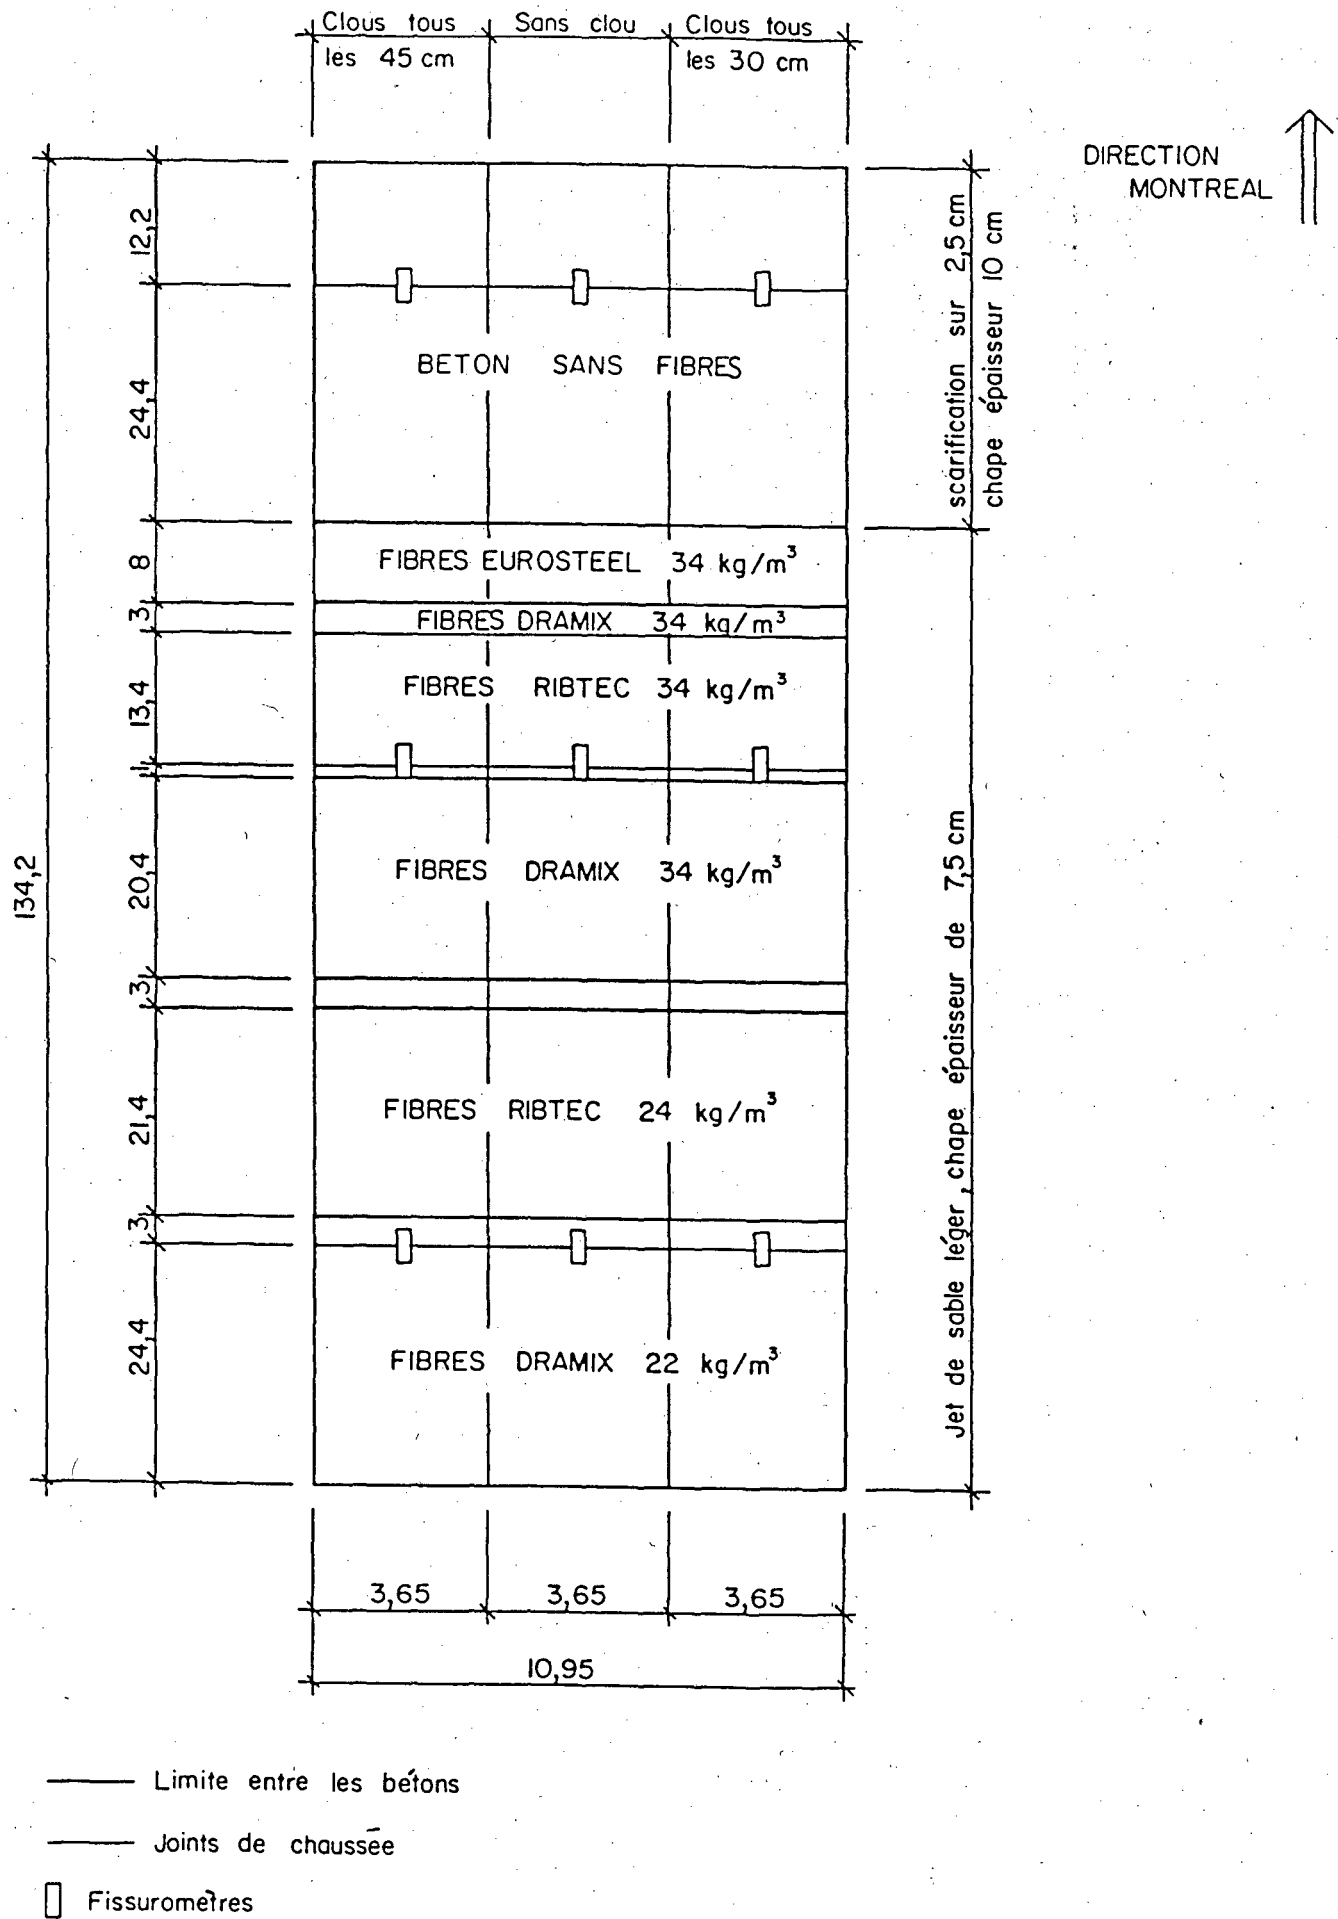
Autoroute 40 - Construction de chapes minces avec béton renforcé de fibres - Description des planches d'essai.
